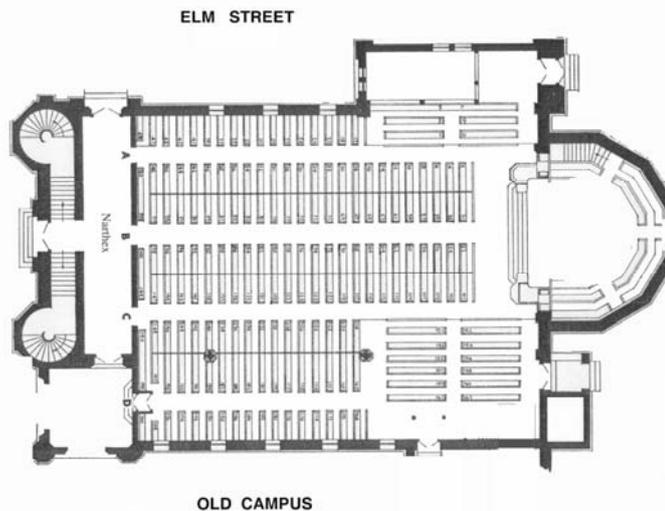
21: Battell Kapelle Grundriss
